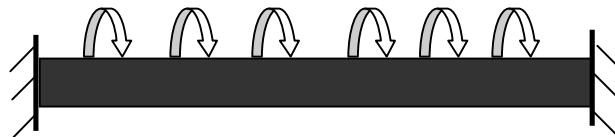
schéma statique de la poutre palier a la torsion.
